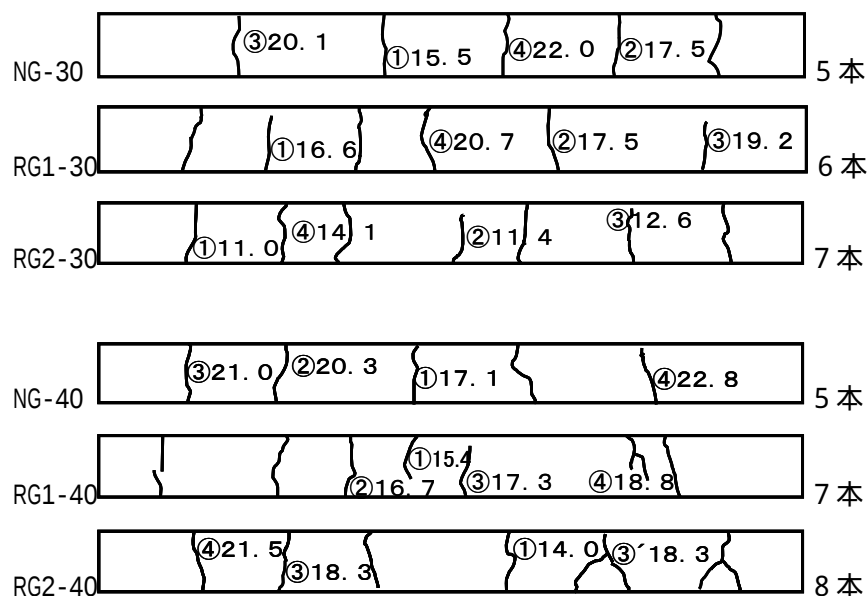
両引き試験供試体のひび割れ発生状況(単位 kN)
